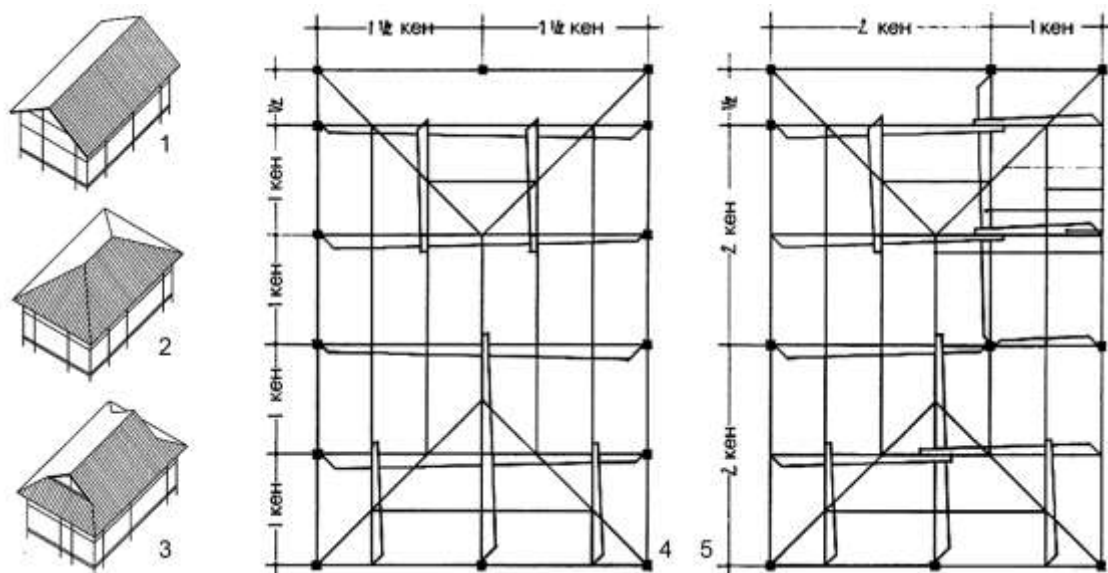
Конструктивные особенности крыши: 1-двухскатные крыши; 2-вальмовые крыши; 3-полувальмовые крыши; 4-безопорная схема раскладки балок и прогонов; 5-раскладка с опорой на священную колонну.
